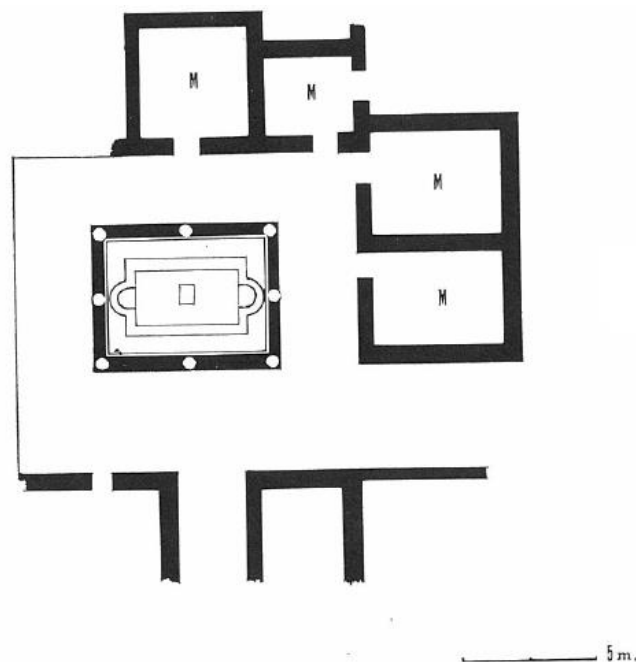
Planimetría de la *villa* de Fuente de las Piedras.
